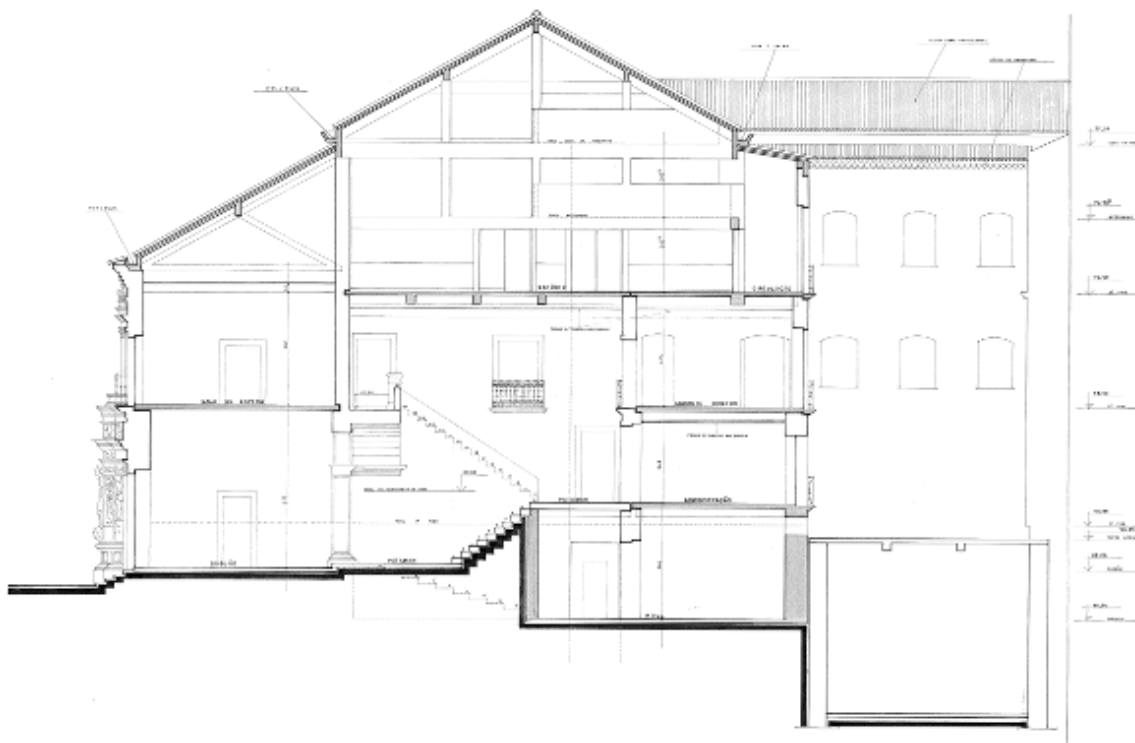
Projeto de Restauração do Paço do Saldanha elaborado por Rebouças com a colaboração da Prado Valladares Arquitetos S/C – Corte (Fonte: Arquivo da Prado Valladares Arquitetos S/C)
